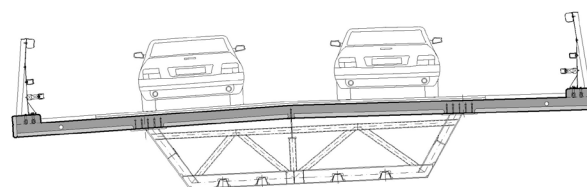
Nueva sección tipo de la E-2 en la zona próxima al estribo 2
